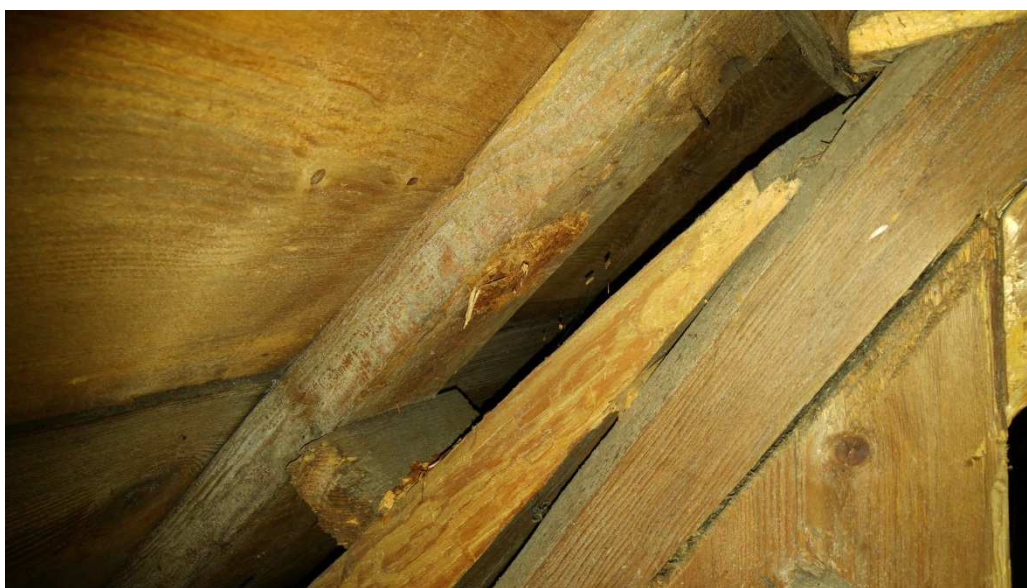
i 9 – storczyk Seg\_1, dach nad prezbiterium i widok frag. ramy storczykowej
